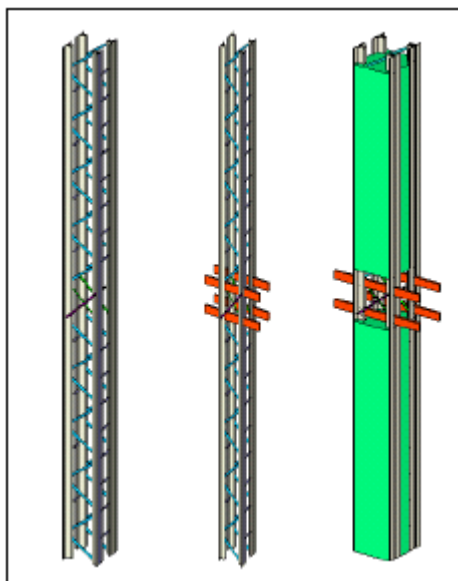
Sistema metallico, inserimento delle lame metalliche, getto di calcestruzzo
